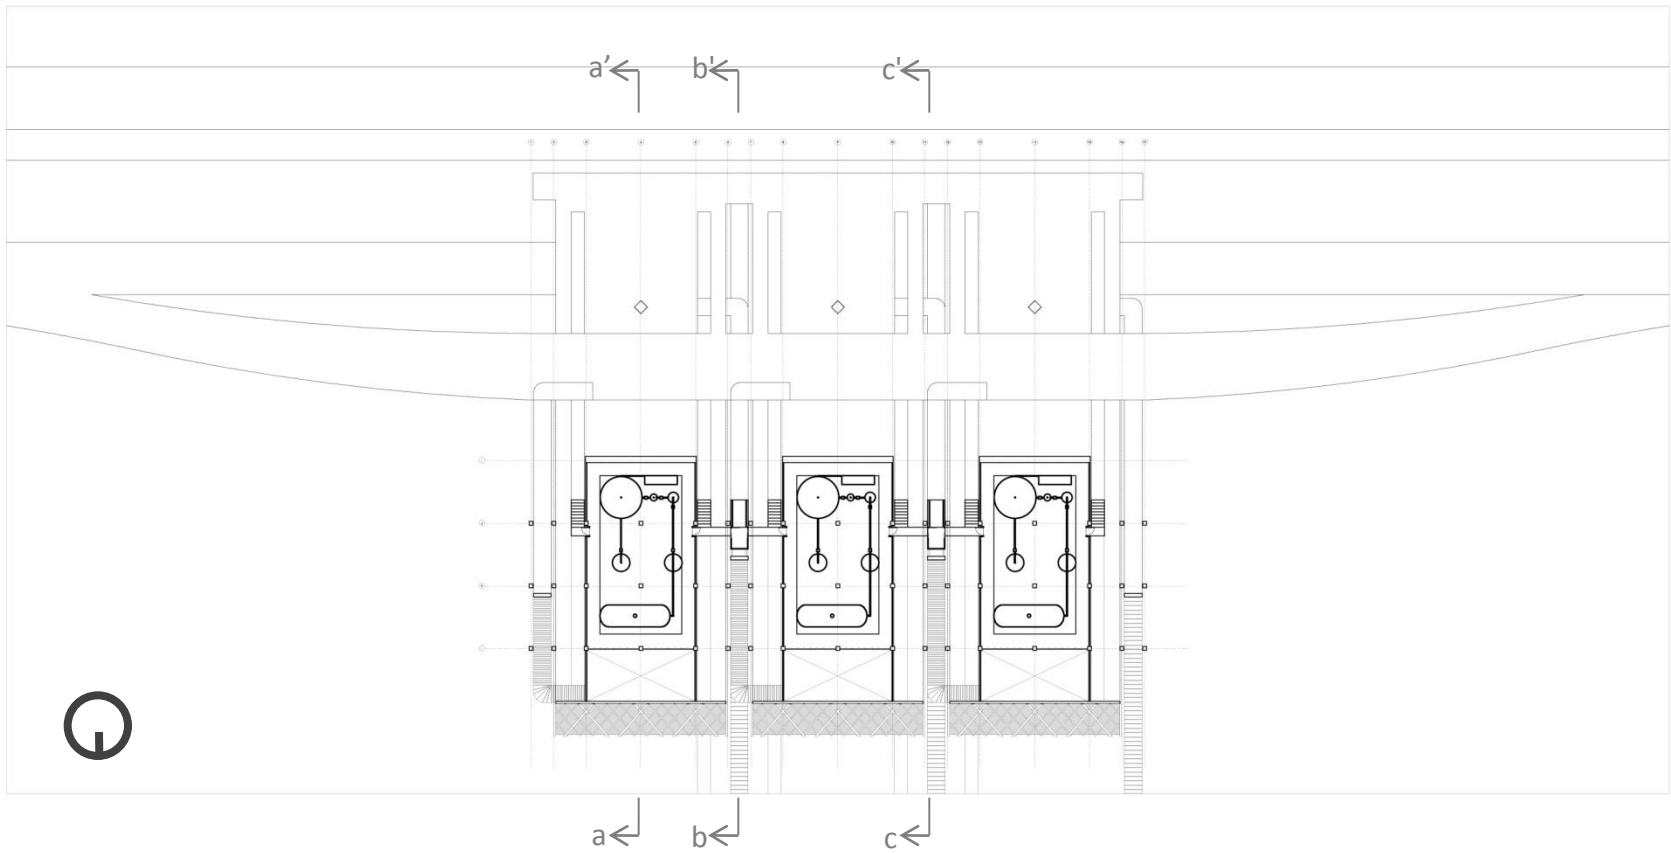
Planta nivel -3_ Salas de producción biogás. esc 1:800
